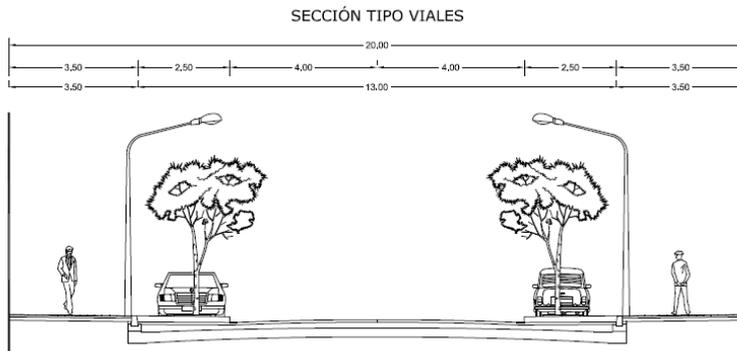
Sección tipo de las calles. 2014 .fuente propia.
